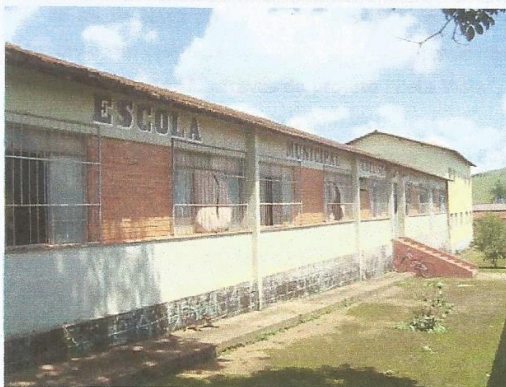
Vista da Fachada Principal da Escola. Novembro/2010
